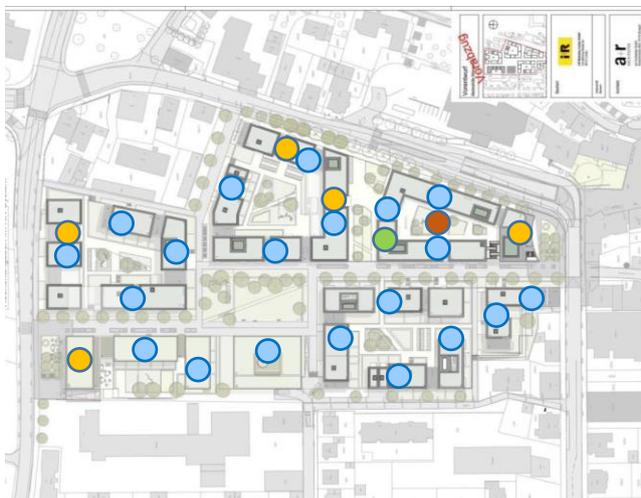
Lageplan mit Darstellung der neuen Fuß- und Radwegeverbindungen und Anbindung an das bestehende Wegenetz
